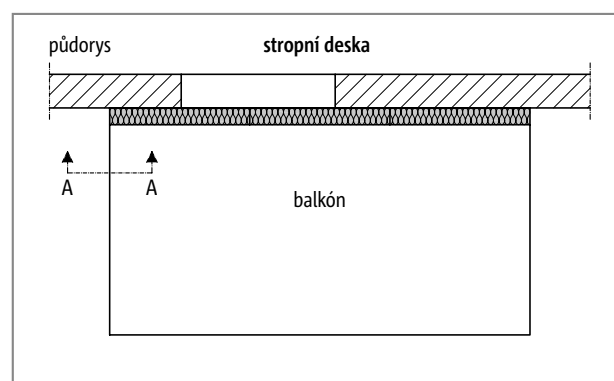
Schöck Isokorb® typ KXT: Napojovací stavební výztuž u nepřímého uložení
